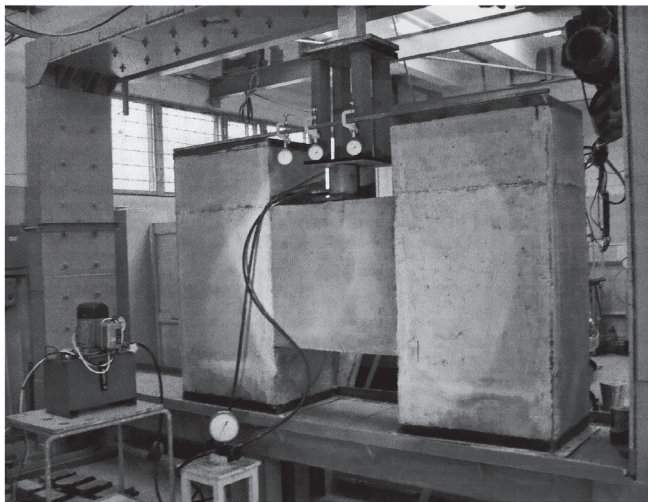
Модель фрагмента перекрытия с системой нагружения гидравлическими домкратами ДГС-63 и прогибомерами
